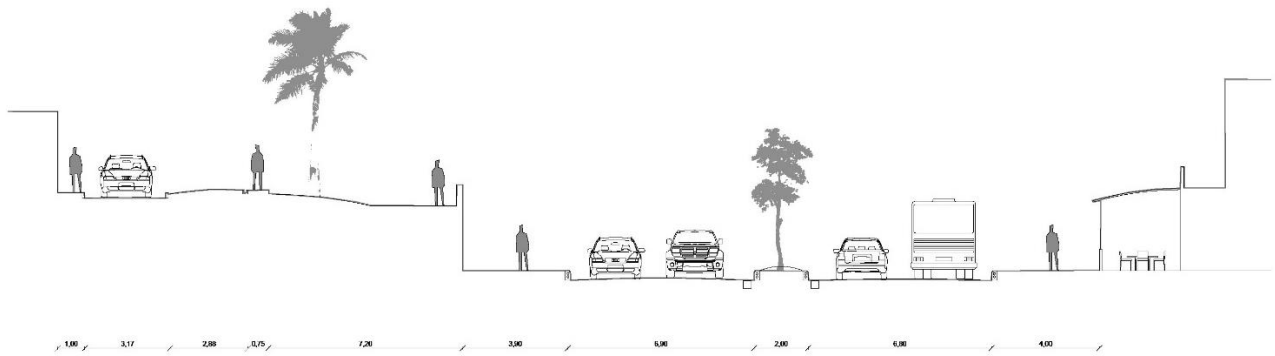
Perfil vial propuesto Carrera 11 tramo zona rosa baja.
